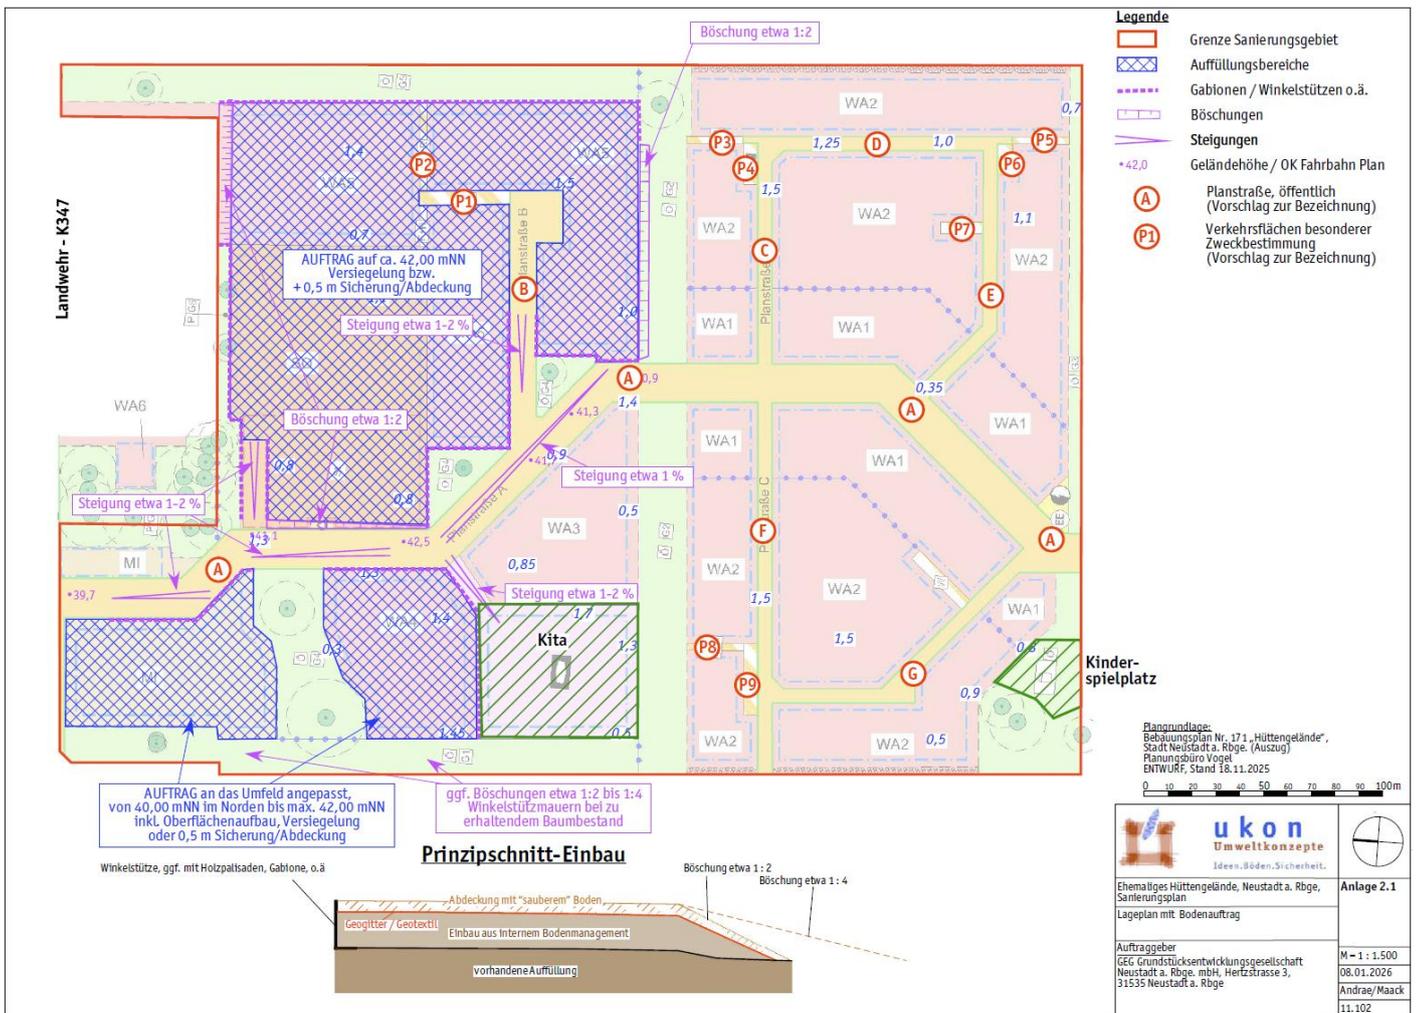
Lageplan mit Bodenauftrag, Sanierungsplan, Anlage 2.1, nicht genordet (ukon 2026)
